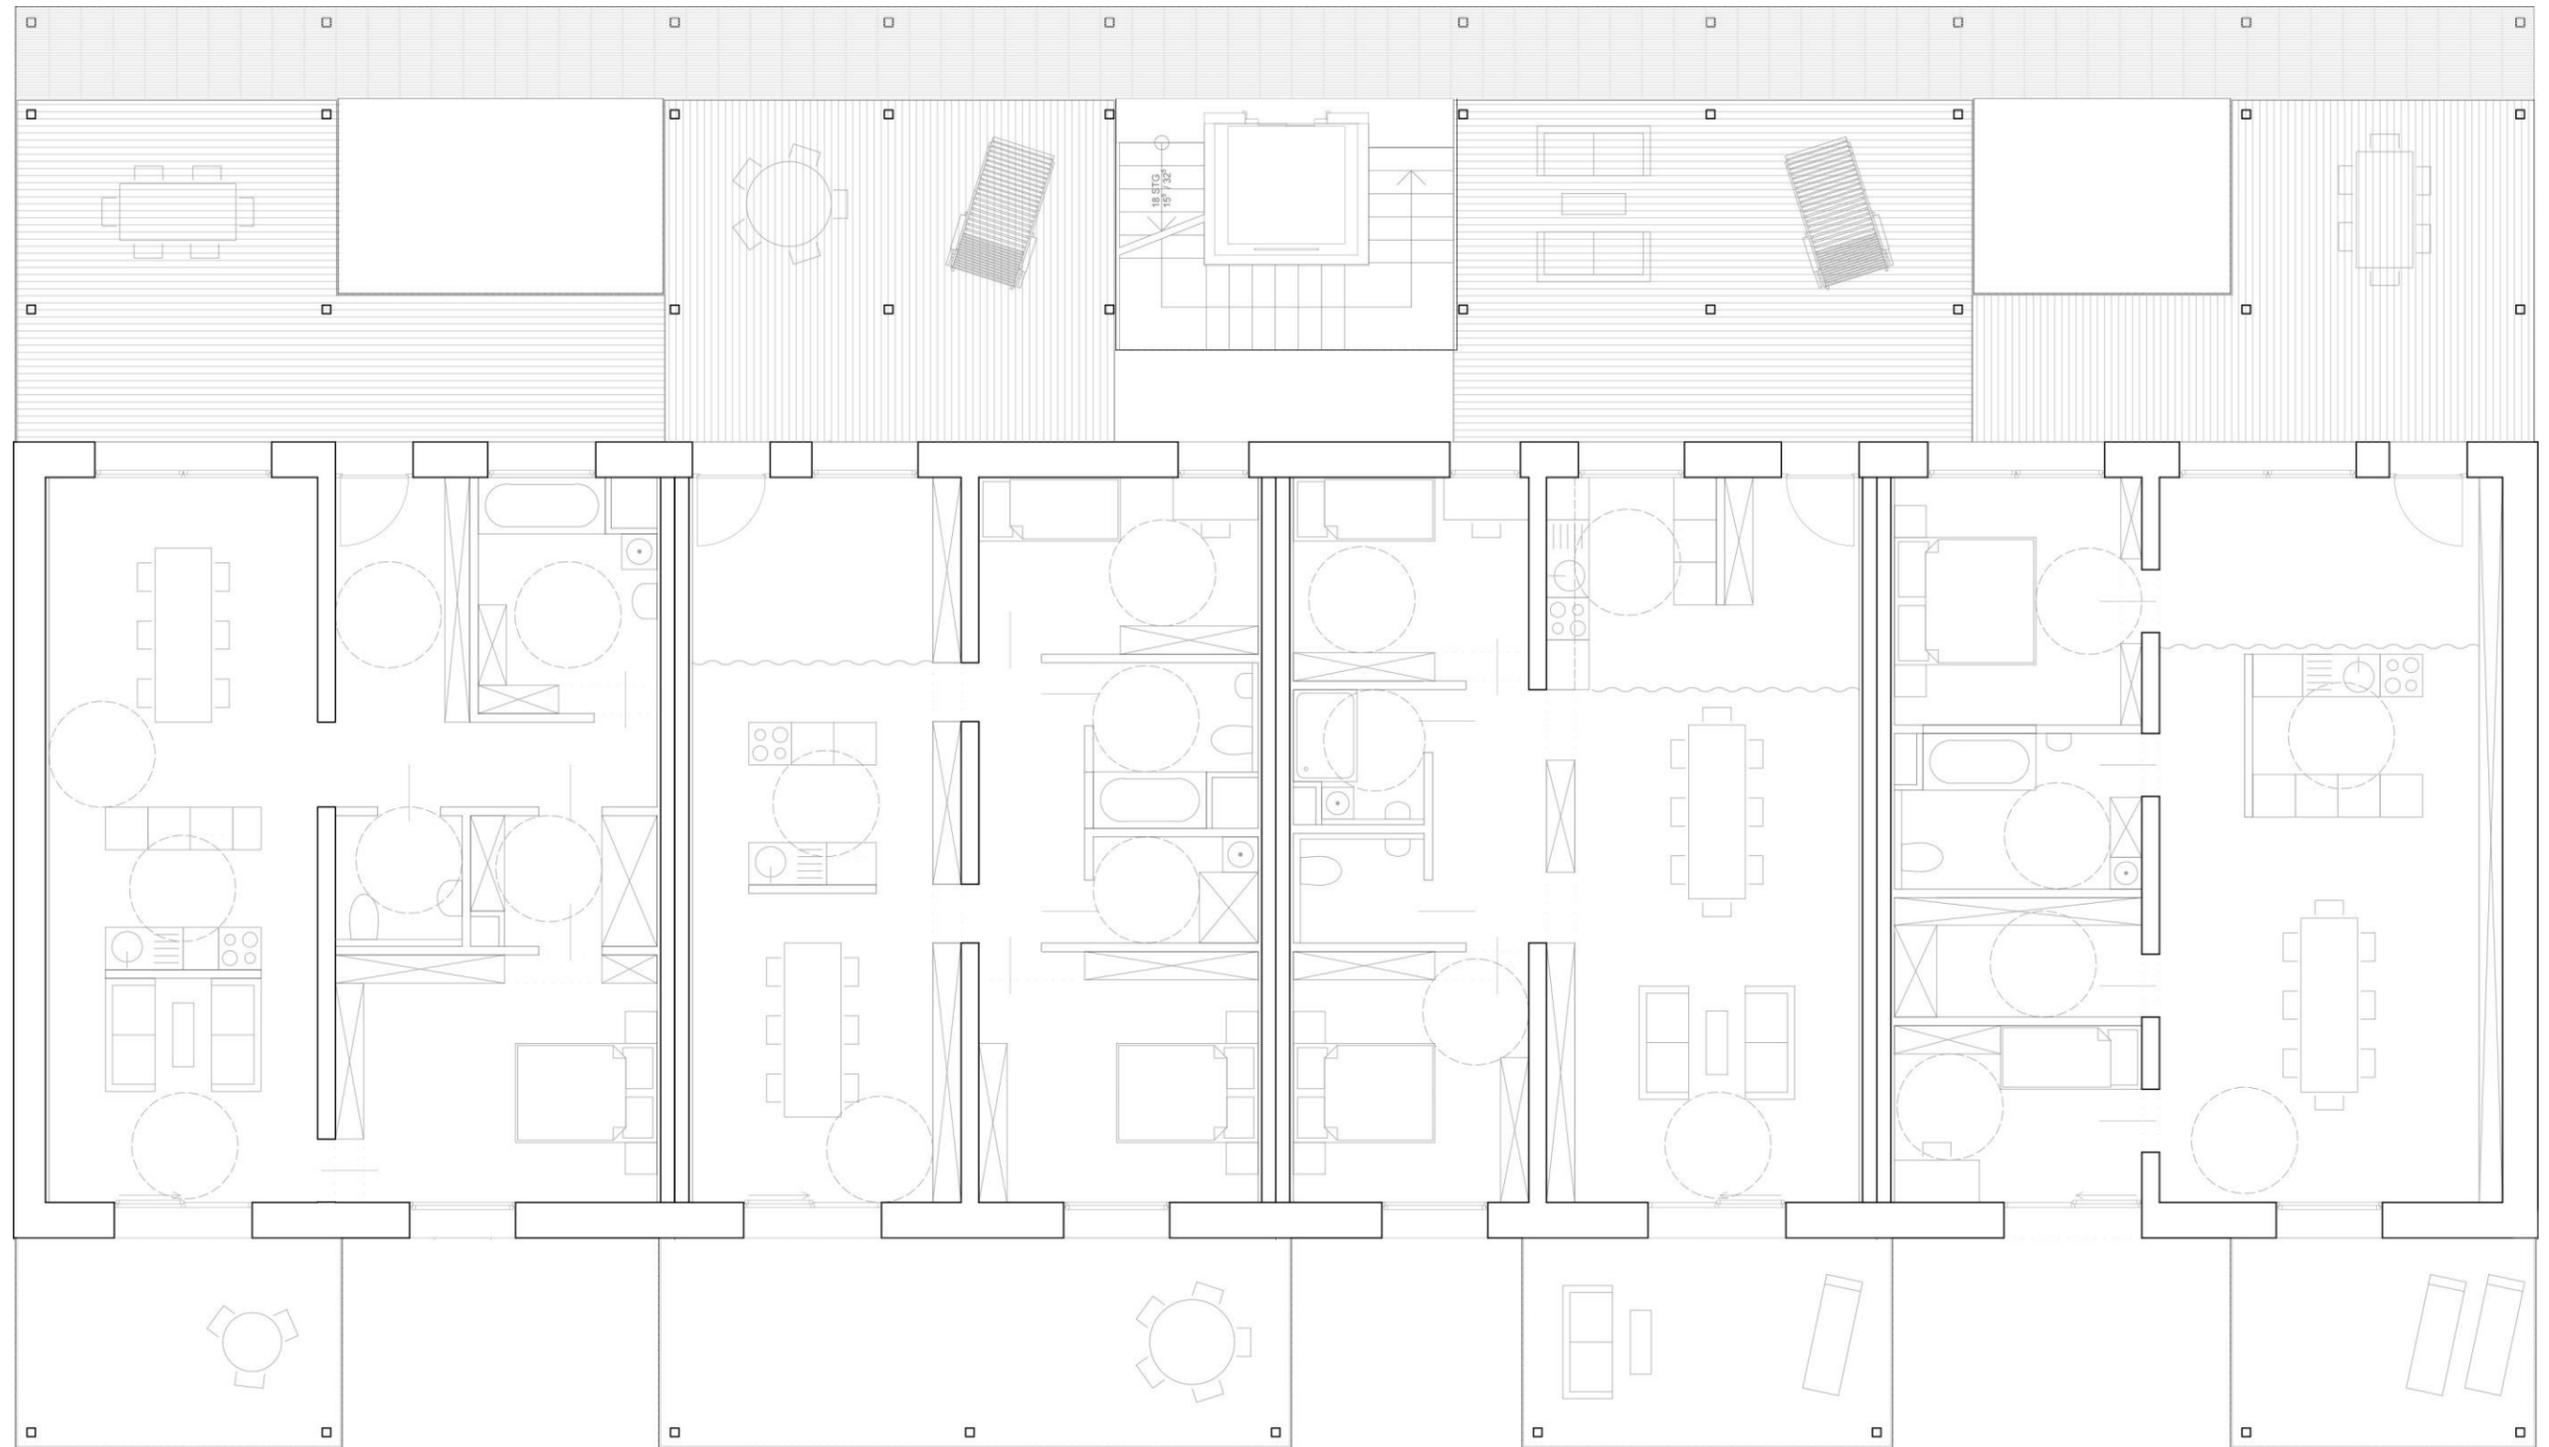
Grundriss 3.Obergeschoss M1:100
